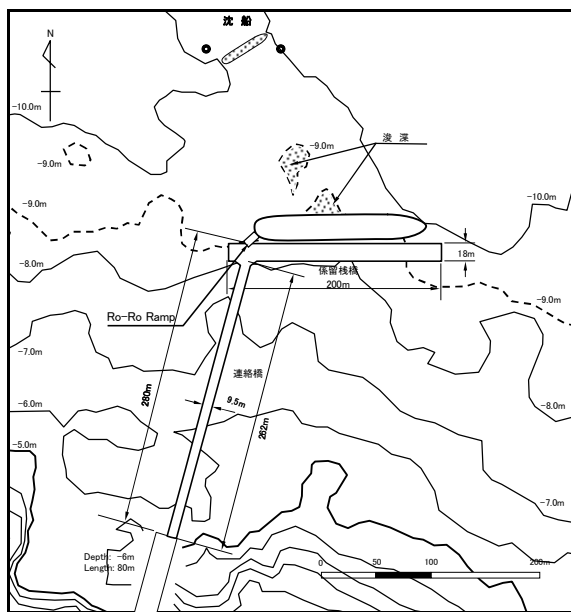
(a) 基本及び代替案(3)の平面計画
